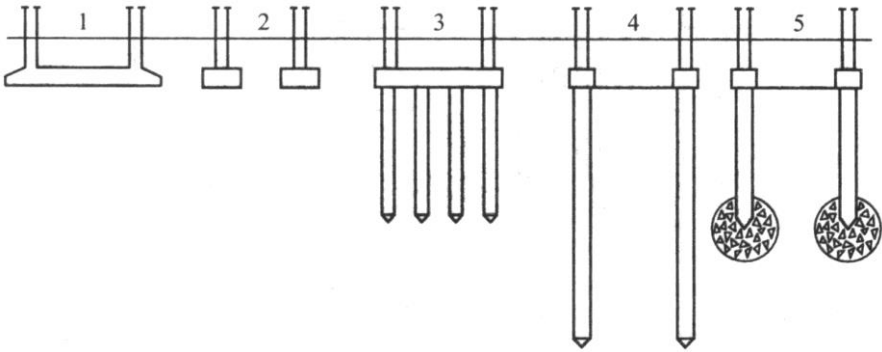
Окремі фундаменти під споруди баштового типу: 1 - суцільна залізобетонна плита; 2 - кільцева залізобетонні плита; 3 - куц забивних паль; 4 - кільцевий пальовий фундамент; 5 – фундамент у пробитих свердловинах з розширенням у нижній частині з утрамбованого щебеню.
